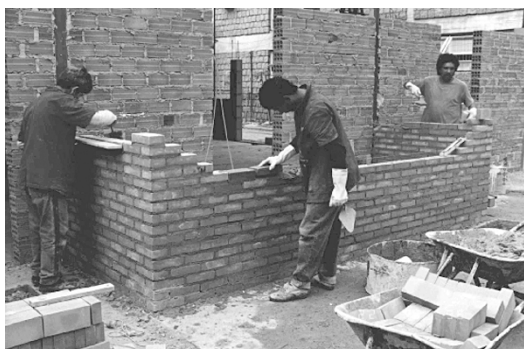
Construção de paredes de vedação com tijolos CIPECAL
